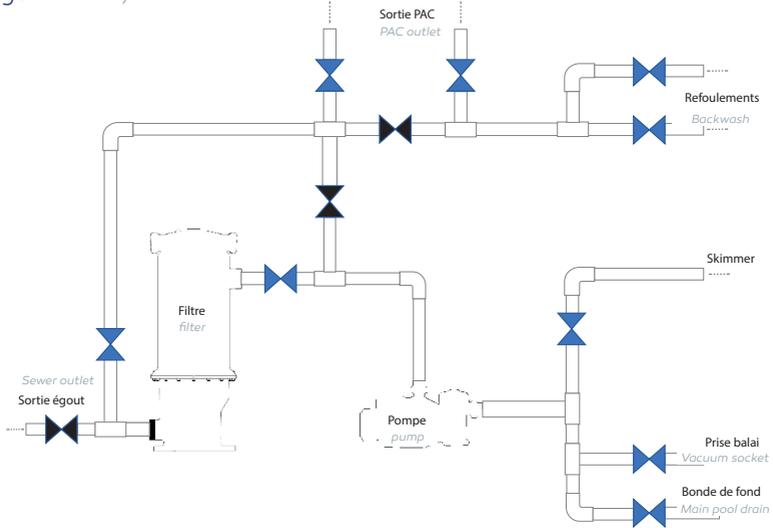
Schéma montage • Figure 5 – Schema for assembly
